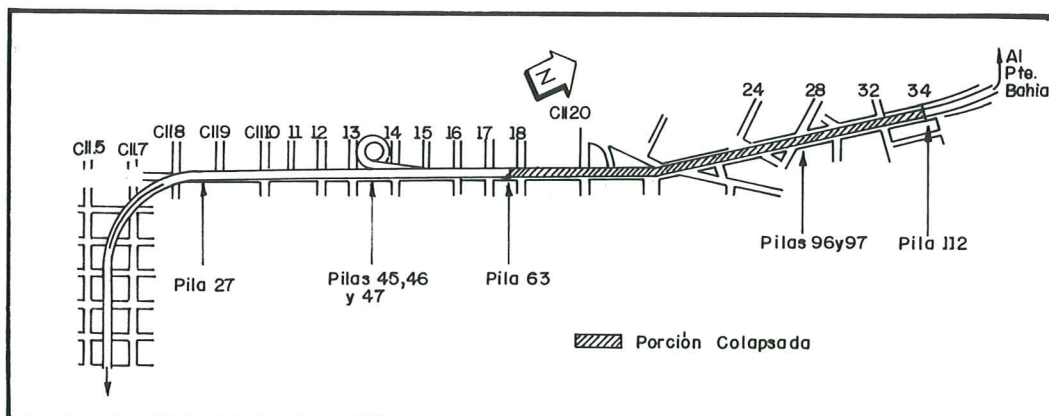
Vista en planta del Viaducto Cypress Street, (Benuska, 1990).
